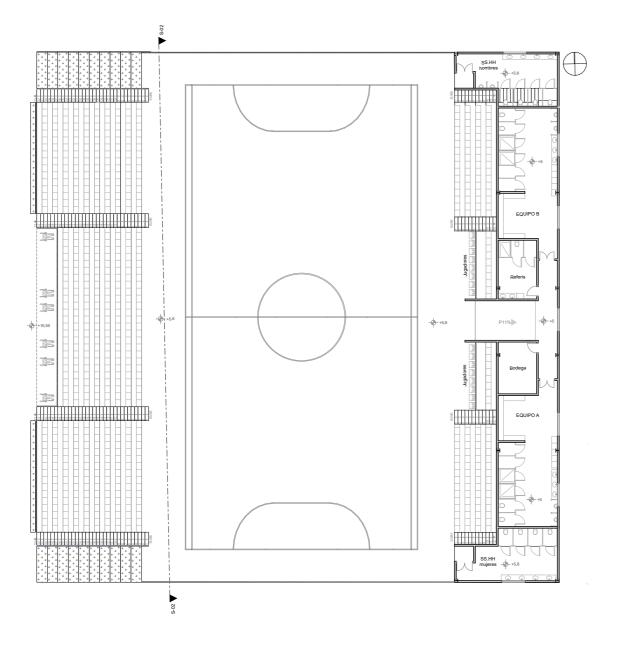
Bloque 4 - planta baja ESC_1:325 Elaborado por: Autor
